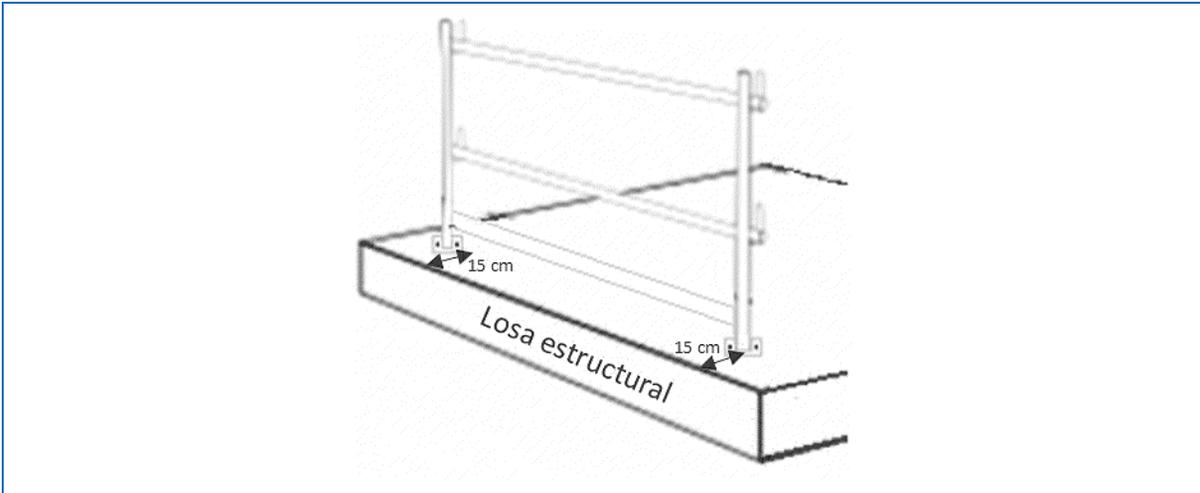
Esquema distanciamiento del anclaje con el borde de losa - Elaboración Propia
